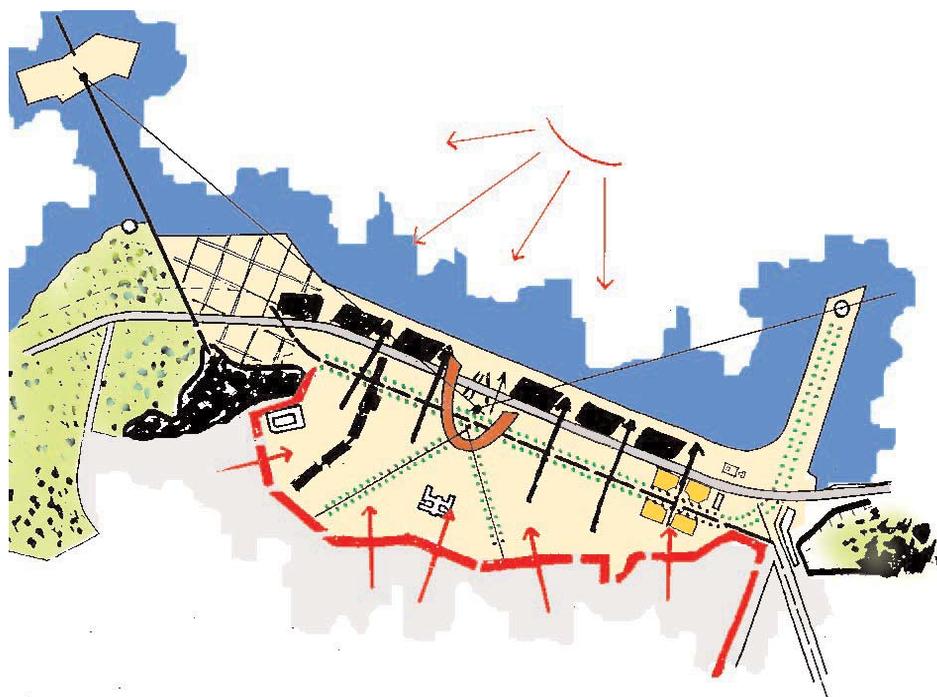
Planta general de la propuesta del arquitecto Jorge Mário Jáuregui para el desarrollo futuro del puerto
